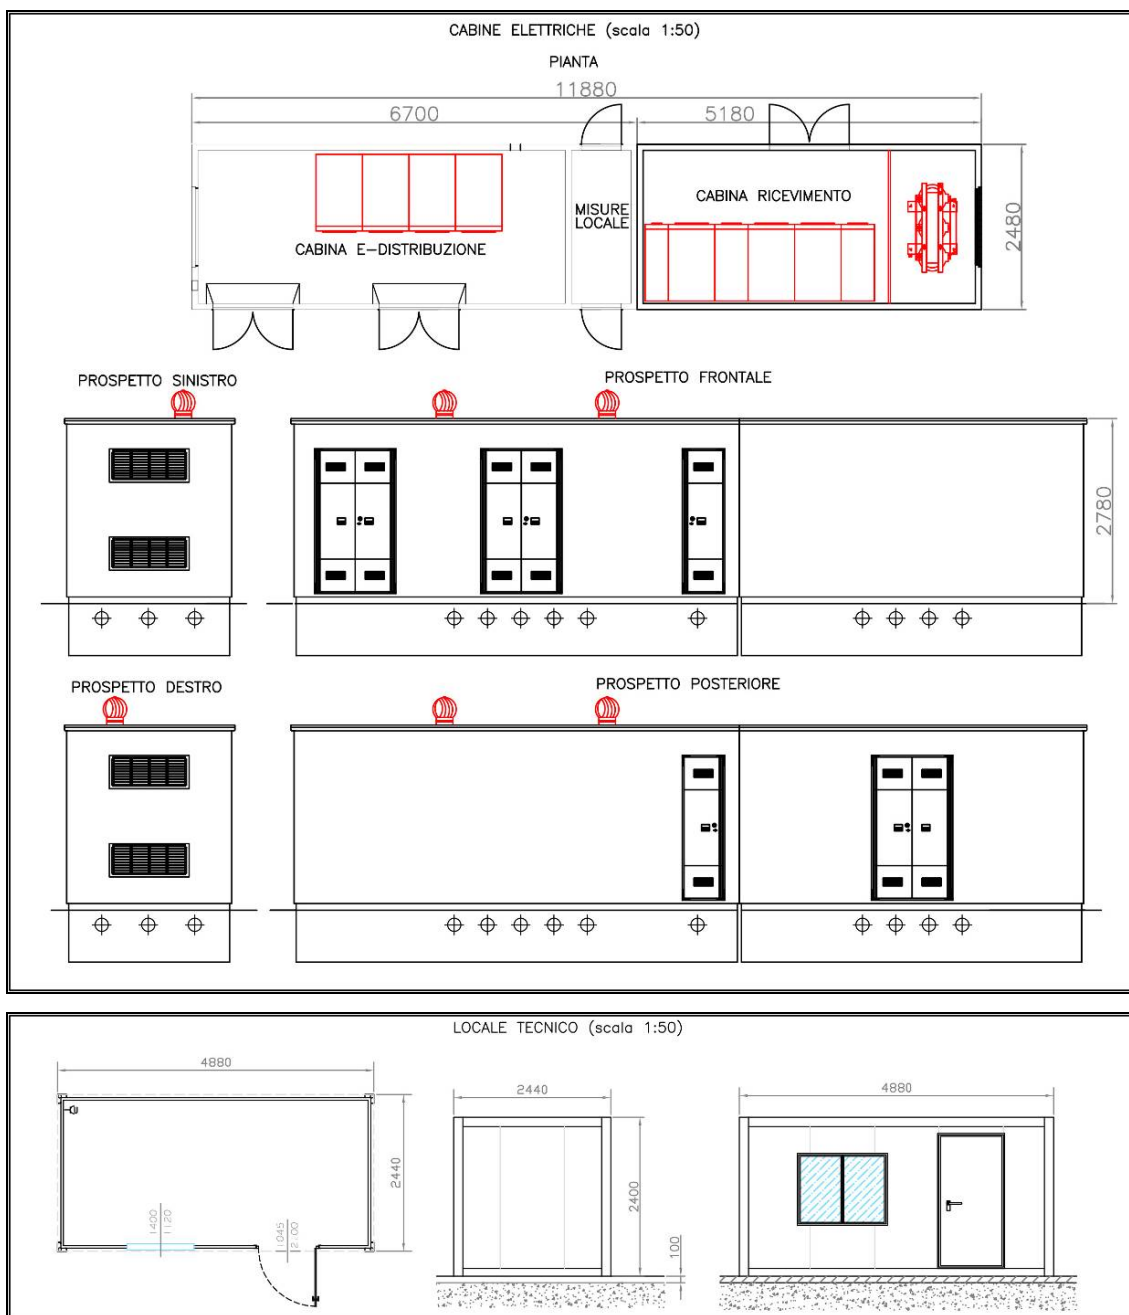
Pianta e prospetti tipo della cabina di ricezione Enel
